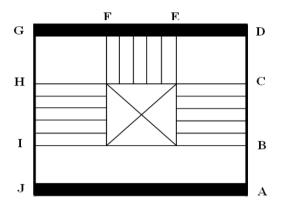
Disposition constructive des armatures de la dalle de compression.
